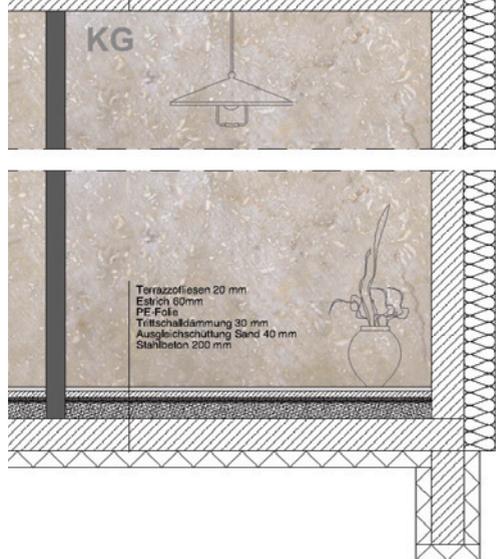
Fassadenschnitt Ansicht Ost M 1:50
